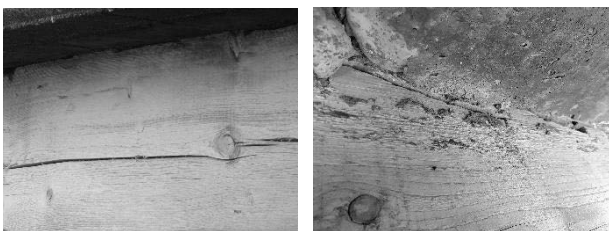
コンクリート床版と木桁の接合部 (左 : B, 右 : A)
